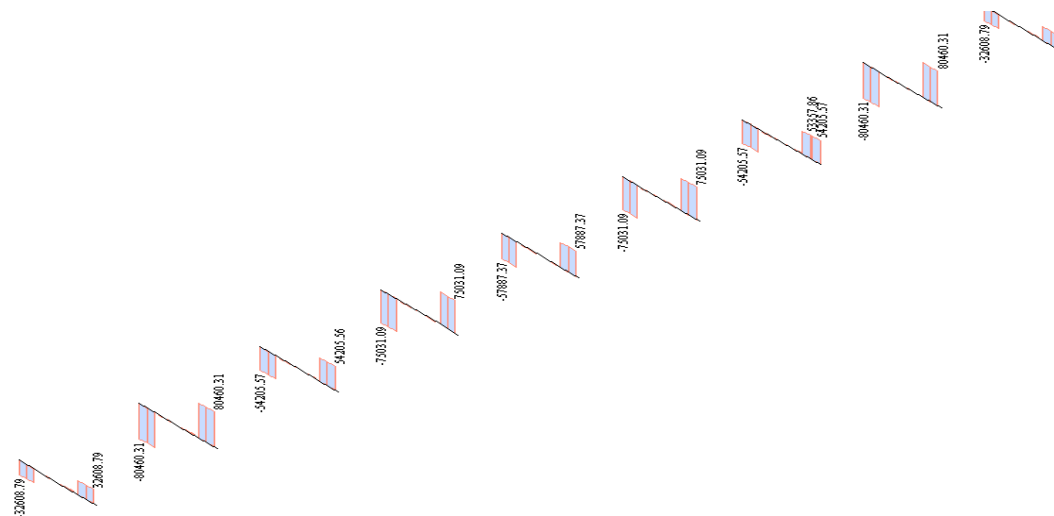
Епюри поперечних сил у поперечних балках, Н
